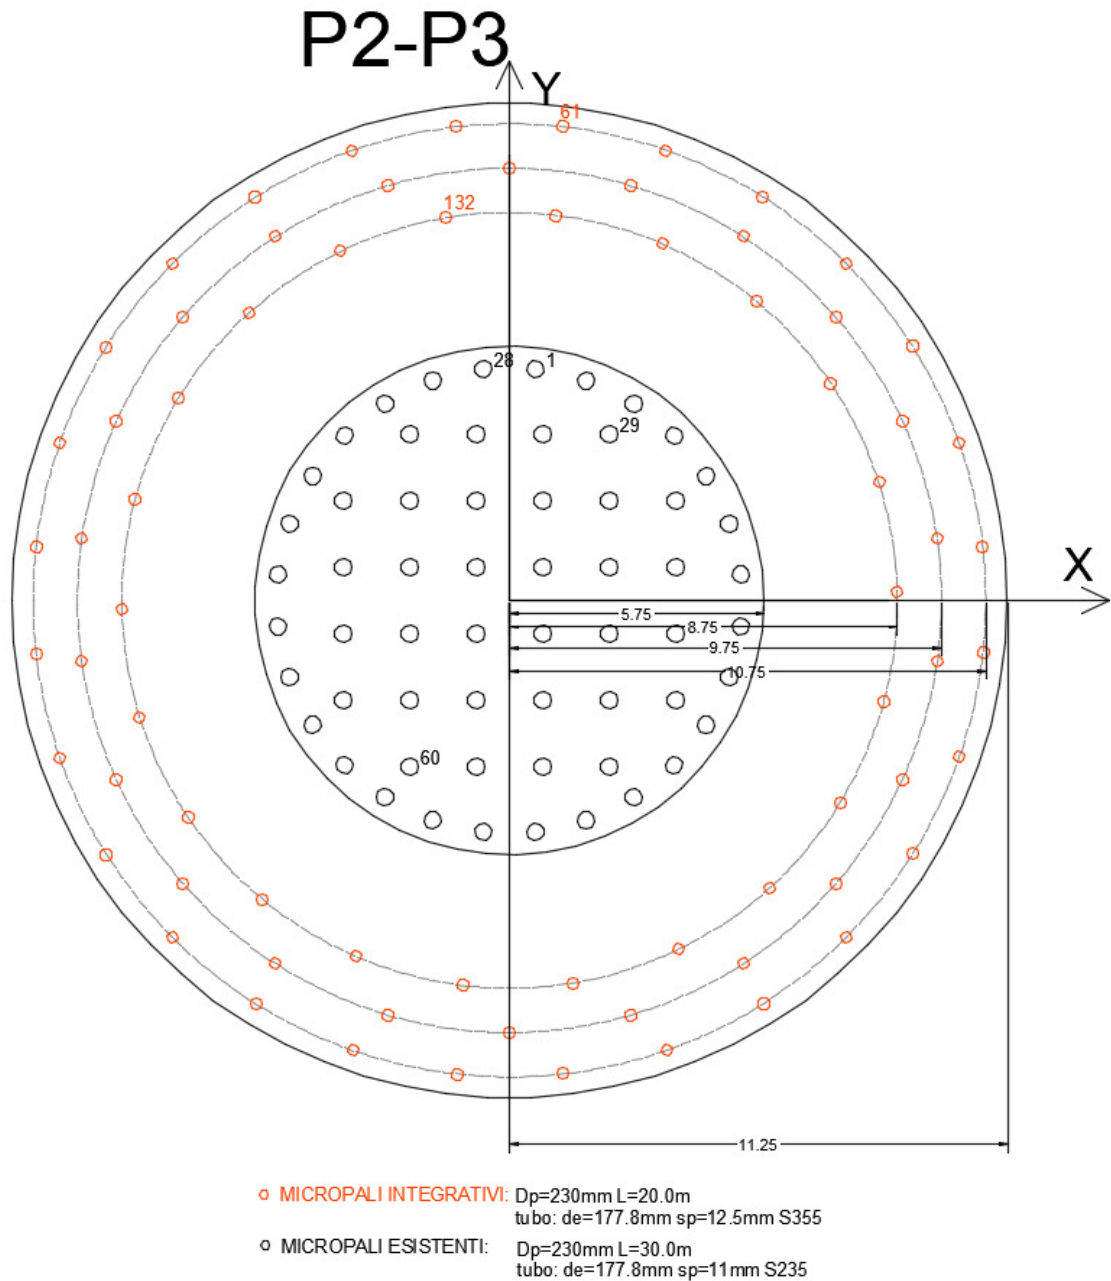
Pila P2, P3 – Configurazione di progetto di miglioramento sismico - pianta
